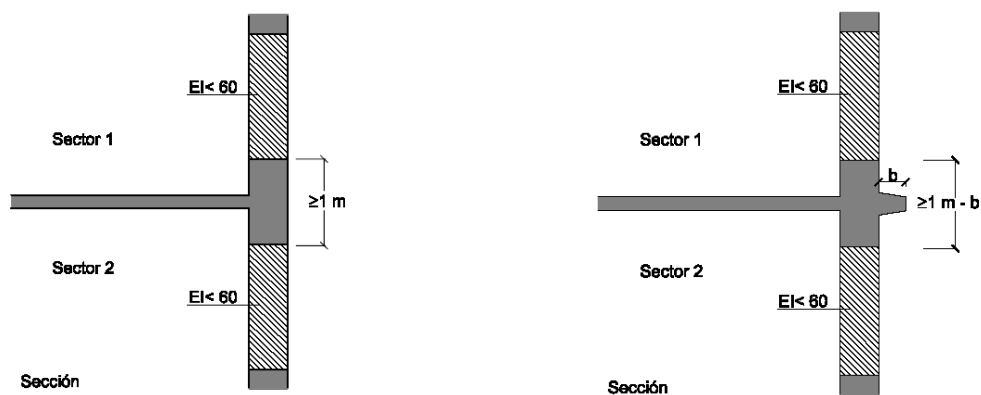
Encuentro forjado-fachada Figura 1. 8 Encuentro forjado- fachada con saliente
